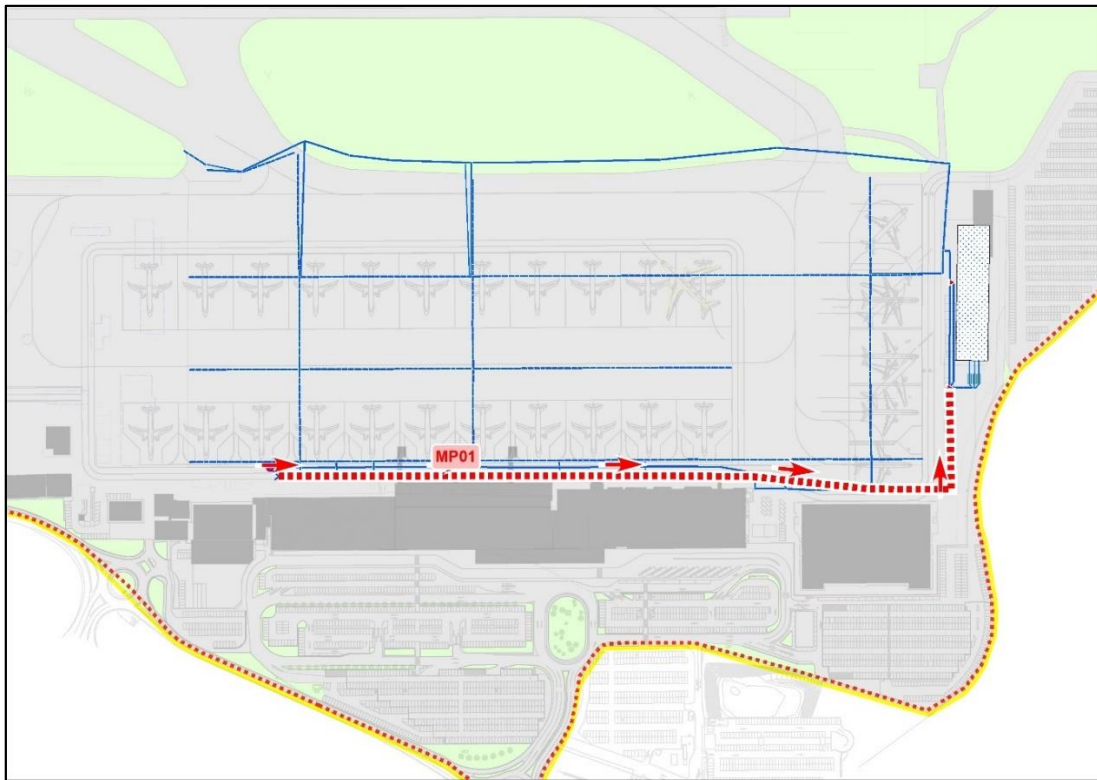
Schema funzionale del sistema di collettamento previsto in sede di Master Plan Idraulico.
